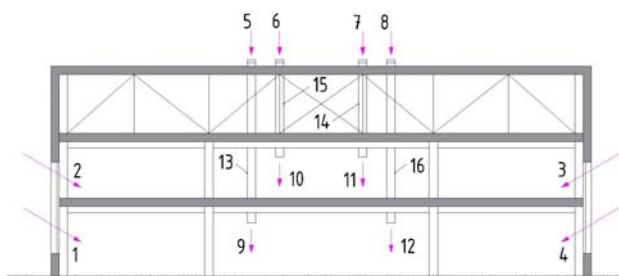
Рассматриваемое производственное здание после второго этапа перепрофилирования с полами световодами: 1-4 – прямые световые потоки от окон; 5-8 – входные проёмы световодов; 9-12 – выходные проёмы световодов; 13-16 – световоды системы верхнего естественного света.
